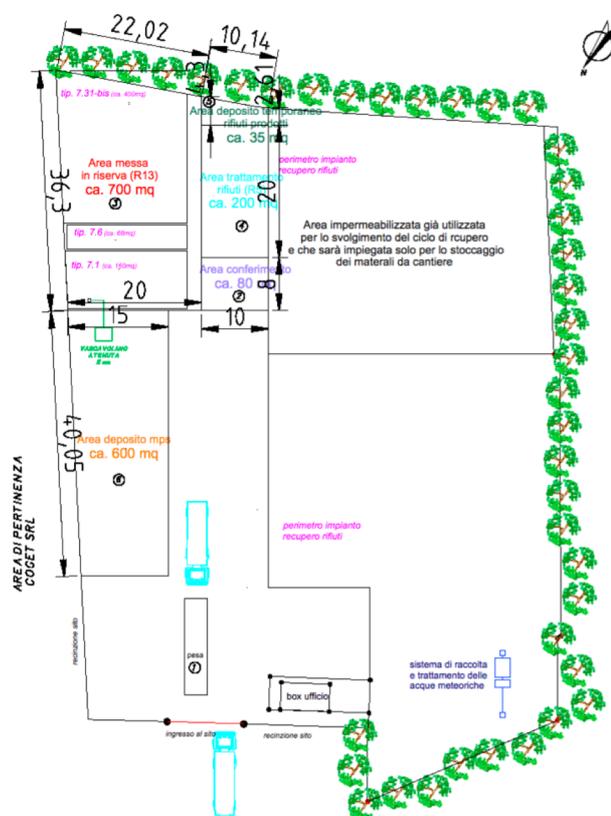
Layout dell'impianto di recupero approvato dal CCR-VIA e sottoposto alla modifica sostanziale dell'AUA vigente
